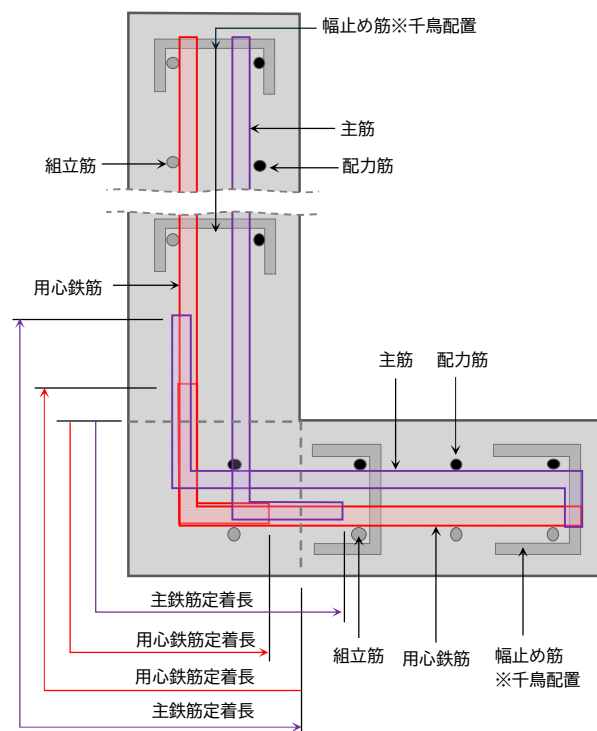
L型鉄筋コンクリート擁壁縦壁基部の配筋要領
